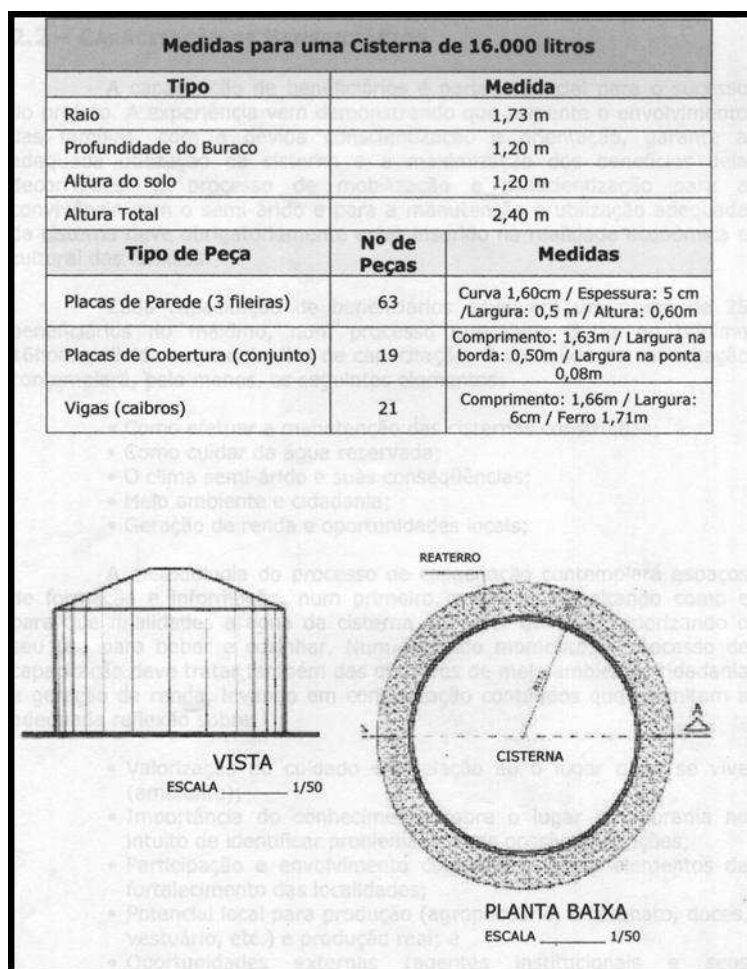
Medidas para uma construção de cisterna de 16.000 litros e vista de uma planta de cisternas. (Fonte: ASA, 2008).
